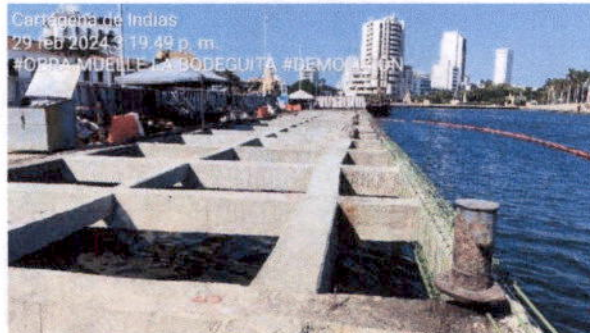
Avance de obra con viga longitudinal 4 demolida e impermeabilizada.
